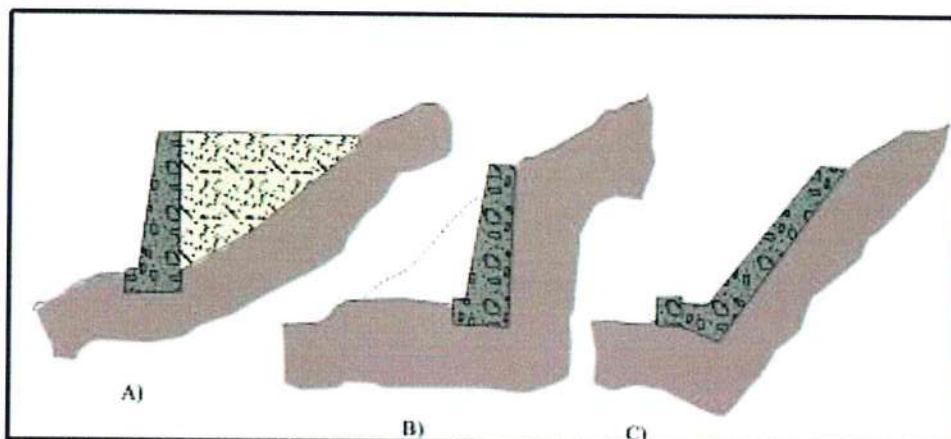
a) Muro de sostenimiento b) Muro de contención c) Muro de revestimiento (tomado de INGEMMET, 2000).
